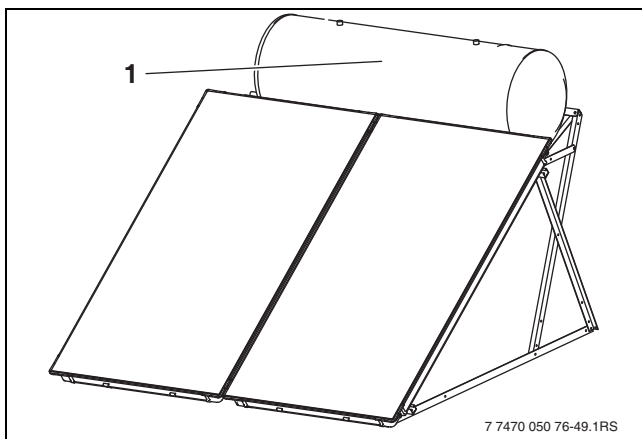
Vista montaje en cubierta plana (sistema de 300 l)
